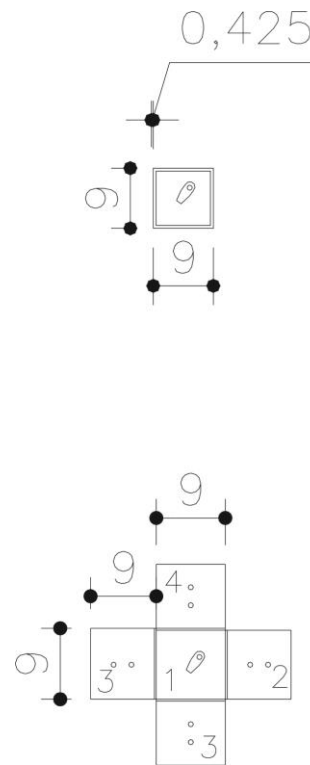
Planta pilar com ligação fixa de topo e expansíveis de topo.
